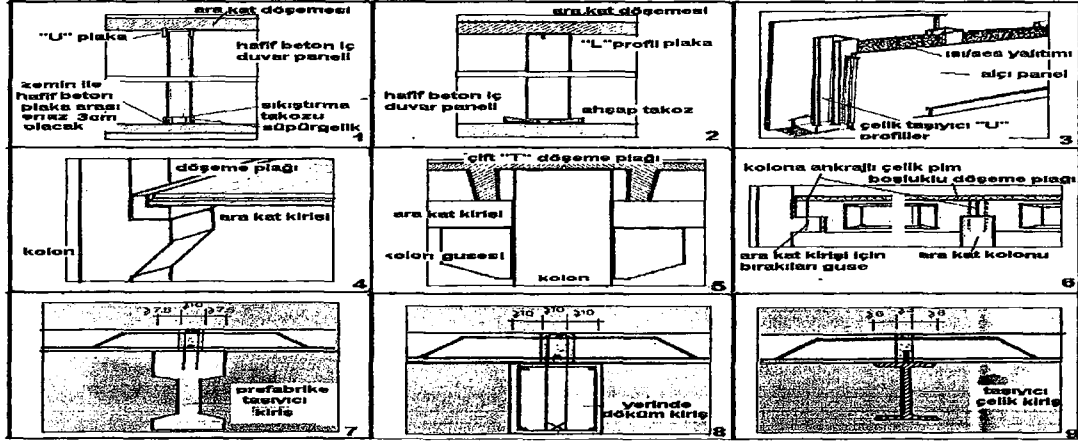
Orta kolon – kiriş birleşim detayları.
